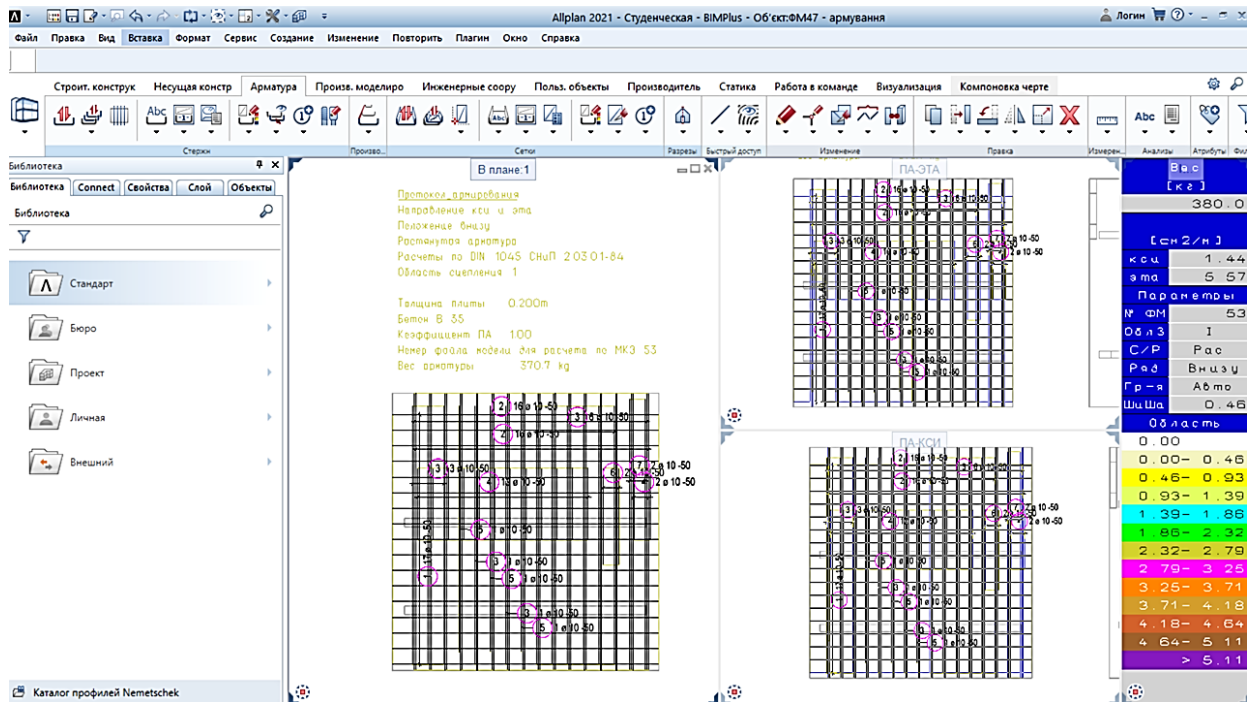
Армування ЗБК з BIMplus та Allplan ПЦБ-51, КНУБА
